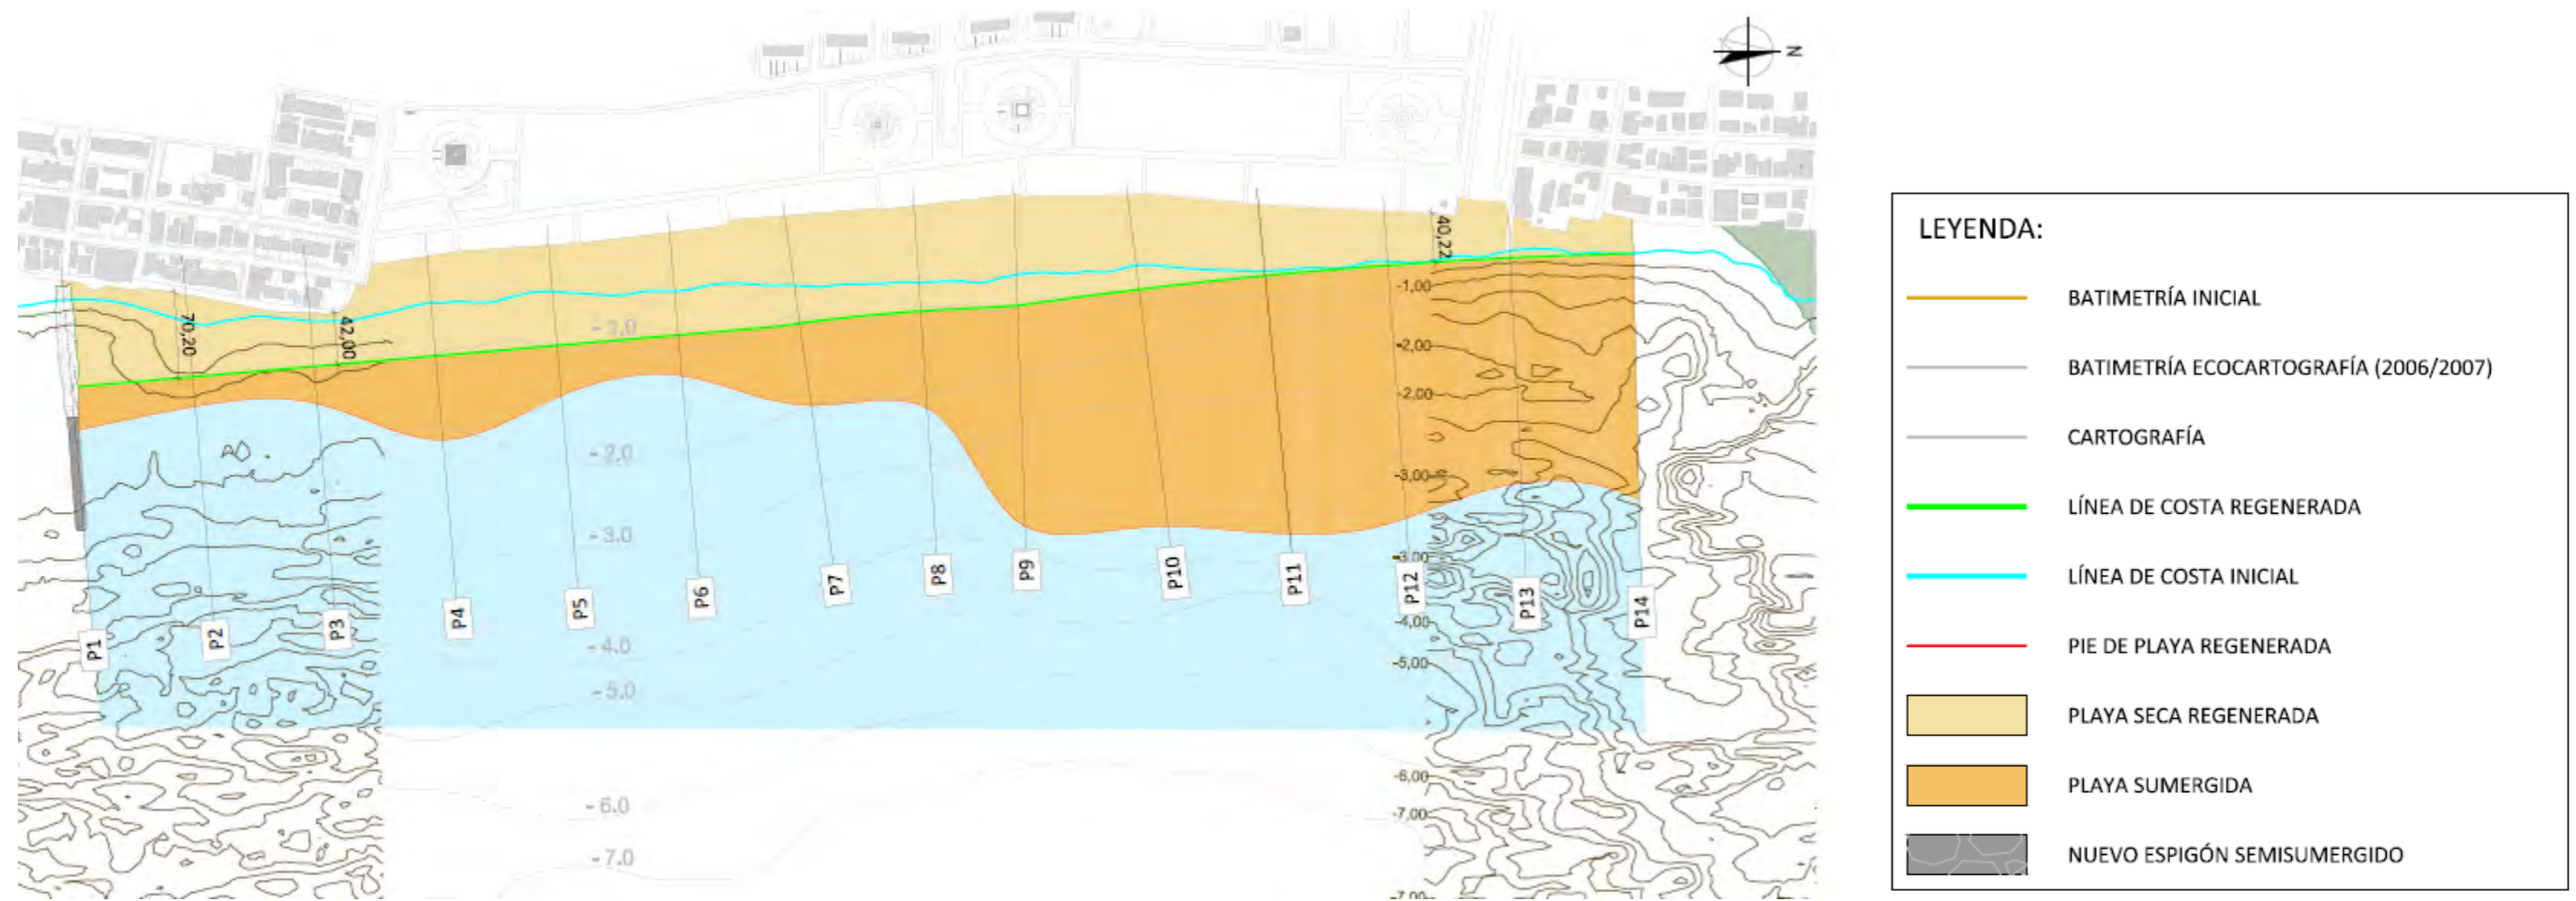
Planta de la actuación de la Alternativa 2 playa del Mojón: espigón semisumergido. Fuente: Elaboración propia.
